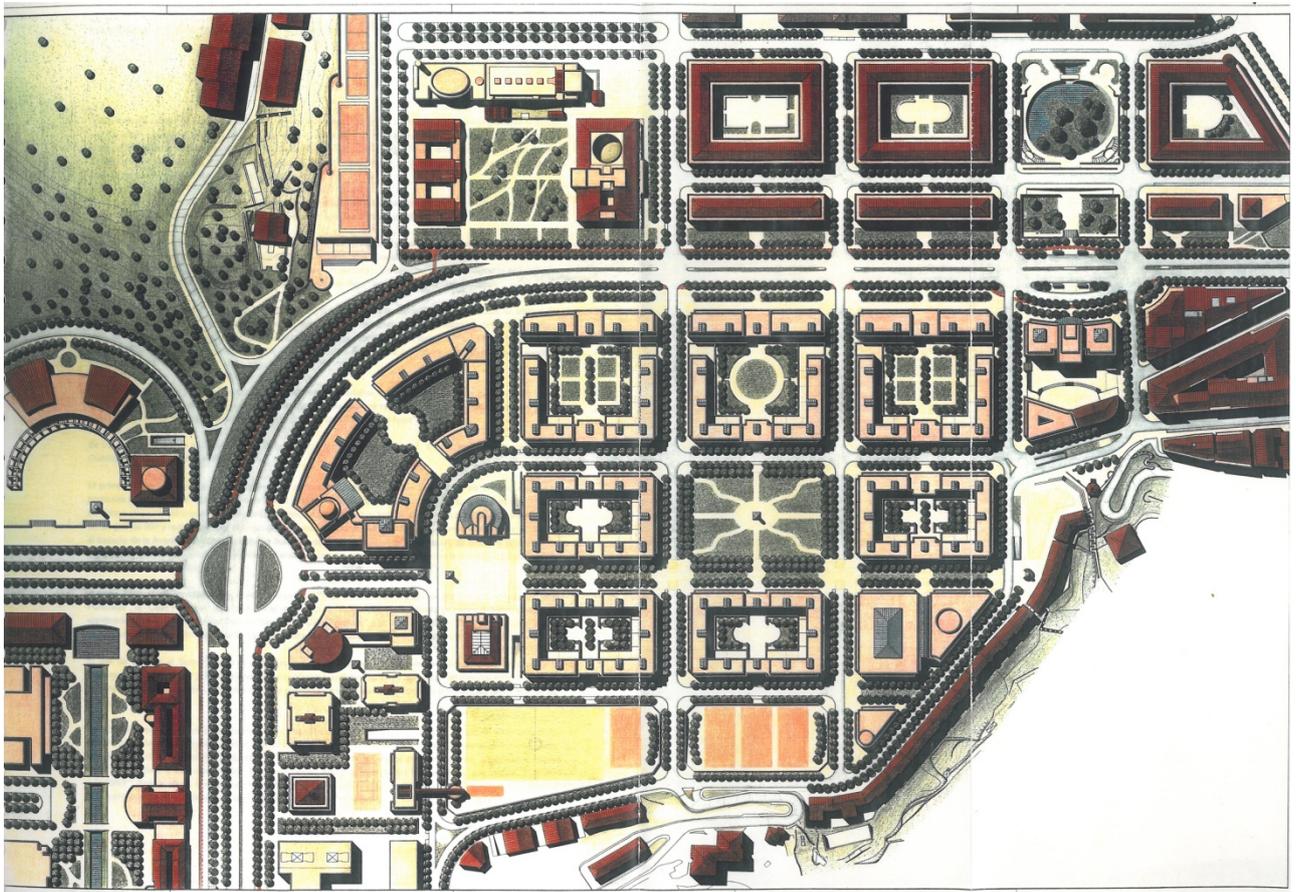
Plano de la propuesta final de la Oficina del Plan General. Planta de cubiertas - P.P.O.P.G.. Pág. 25
